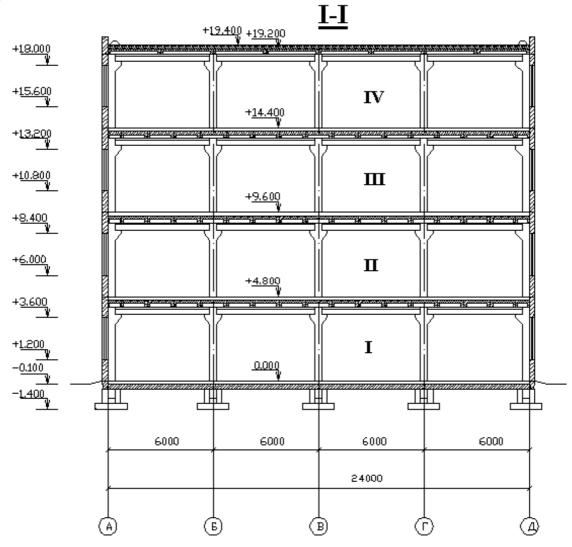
Разрез многоэтажного производственного здания (I – первый этаж; II, III – промежуточные этажи; IV – верхний этаж)
